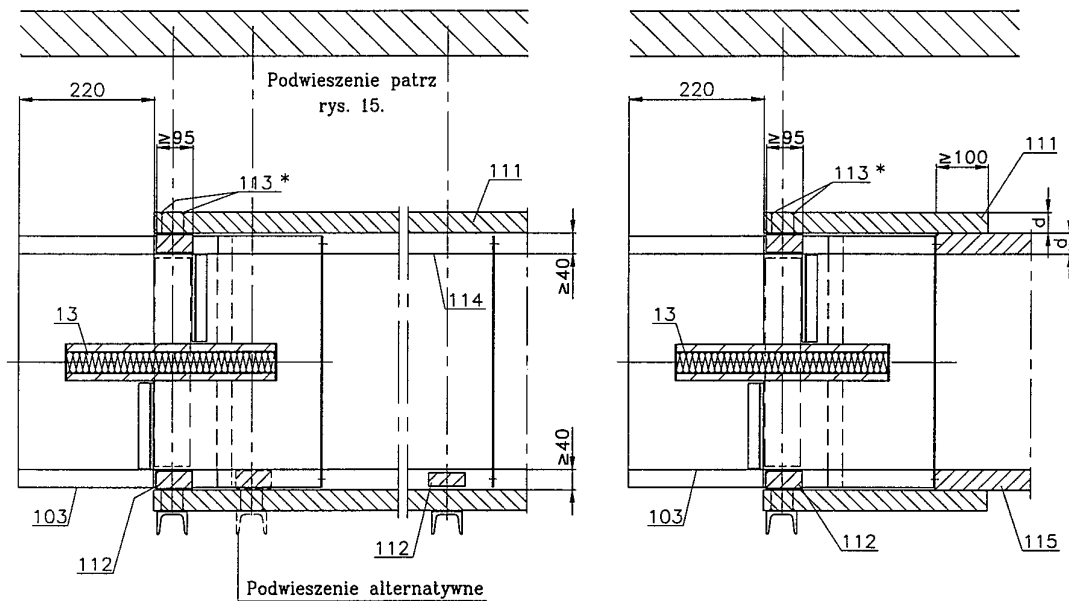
Sposób montażu klapy odcinającej typu BK-326 w przegrodach budowlanych
